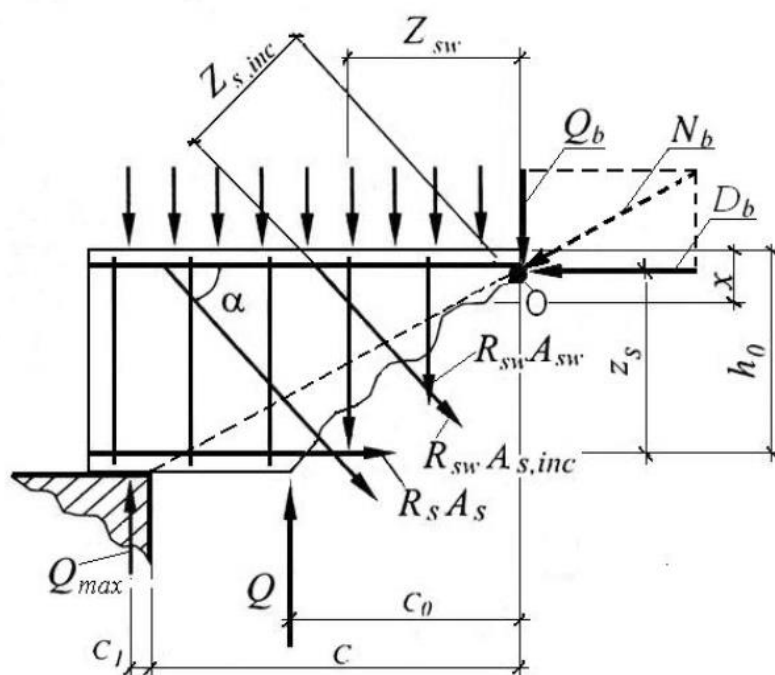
Модель похилих перерізів з поперечною арматурою.
